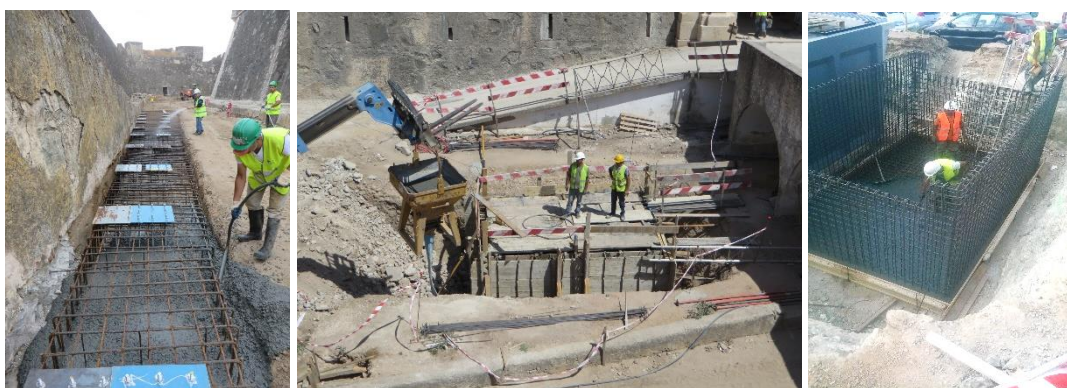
Localização do reforço metálico em cantos exteriores e sua aplicação
